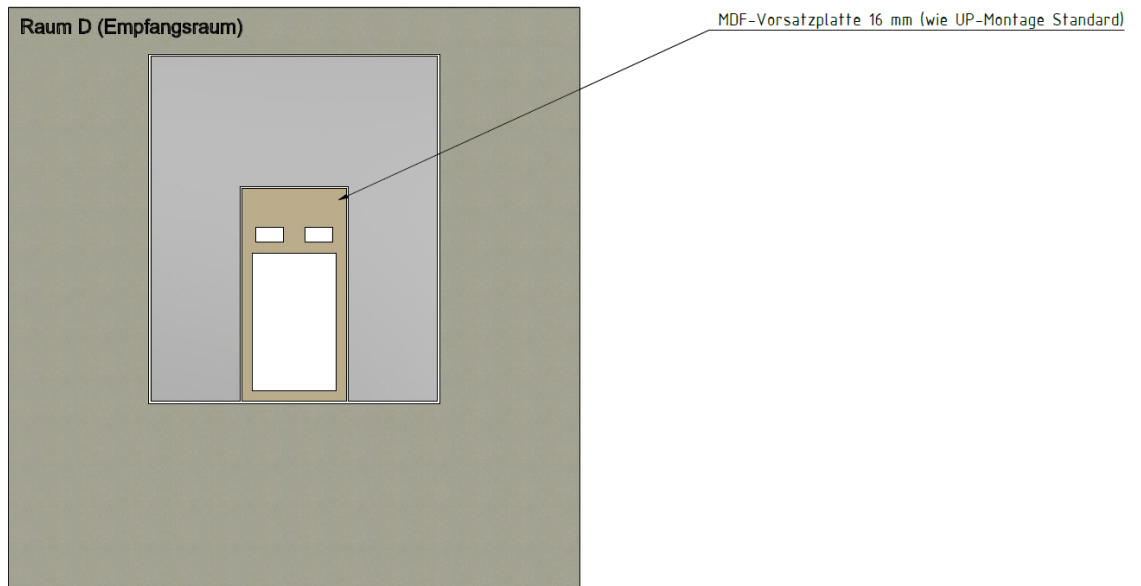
Eingebaute Trockenbaublende mit Öffnungen für die Durchführung von ABL- und ZUL-Kanal (für Varianten mit einem Kanalanschluss einzeln geschlossen).
